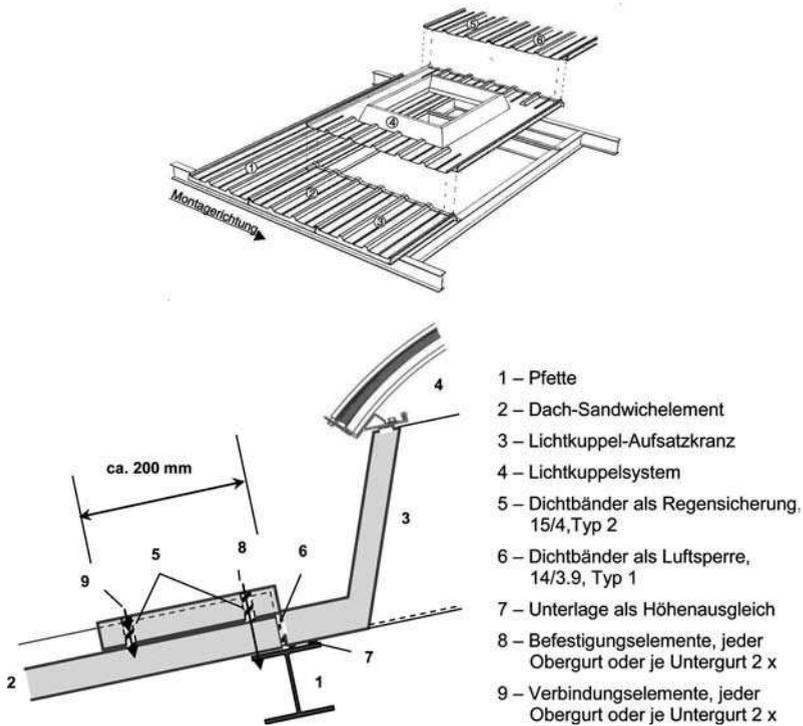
Zweischaliger Aufsatzkranz mit profilfolgenden Flanschen der oberen Deckschale bei Deckungen mit Sandwichelement (Die Ziffern im oberen Bild bezeichnen die Montagerihenfolge.)
